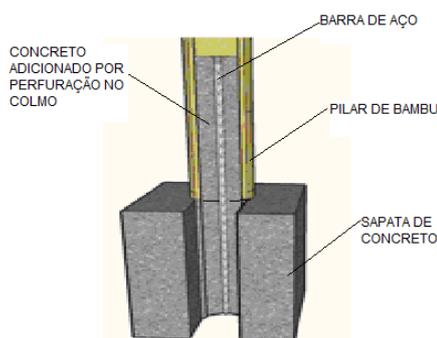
Sistema de apoio com incorporação do pilar a sapata de concreto
